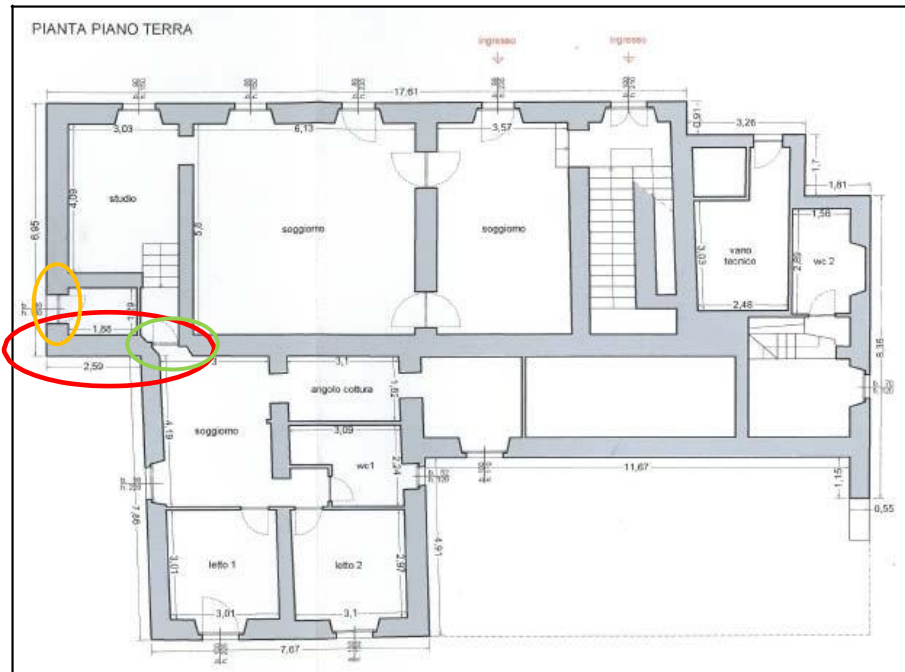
Figura B - Individuazione del maschio murario interessato dalla lesione oggetto di perizia (colore rosso) e delle aperture causa di indebolimento (colore arancione e verde) – Piano terra
